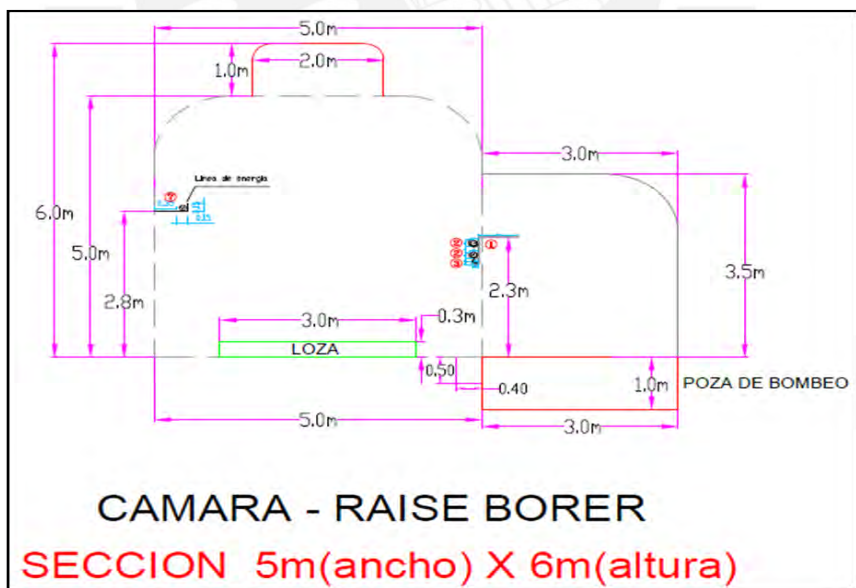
Sección vista frontal de cm Raise Boring proyecto CM RB 650
